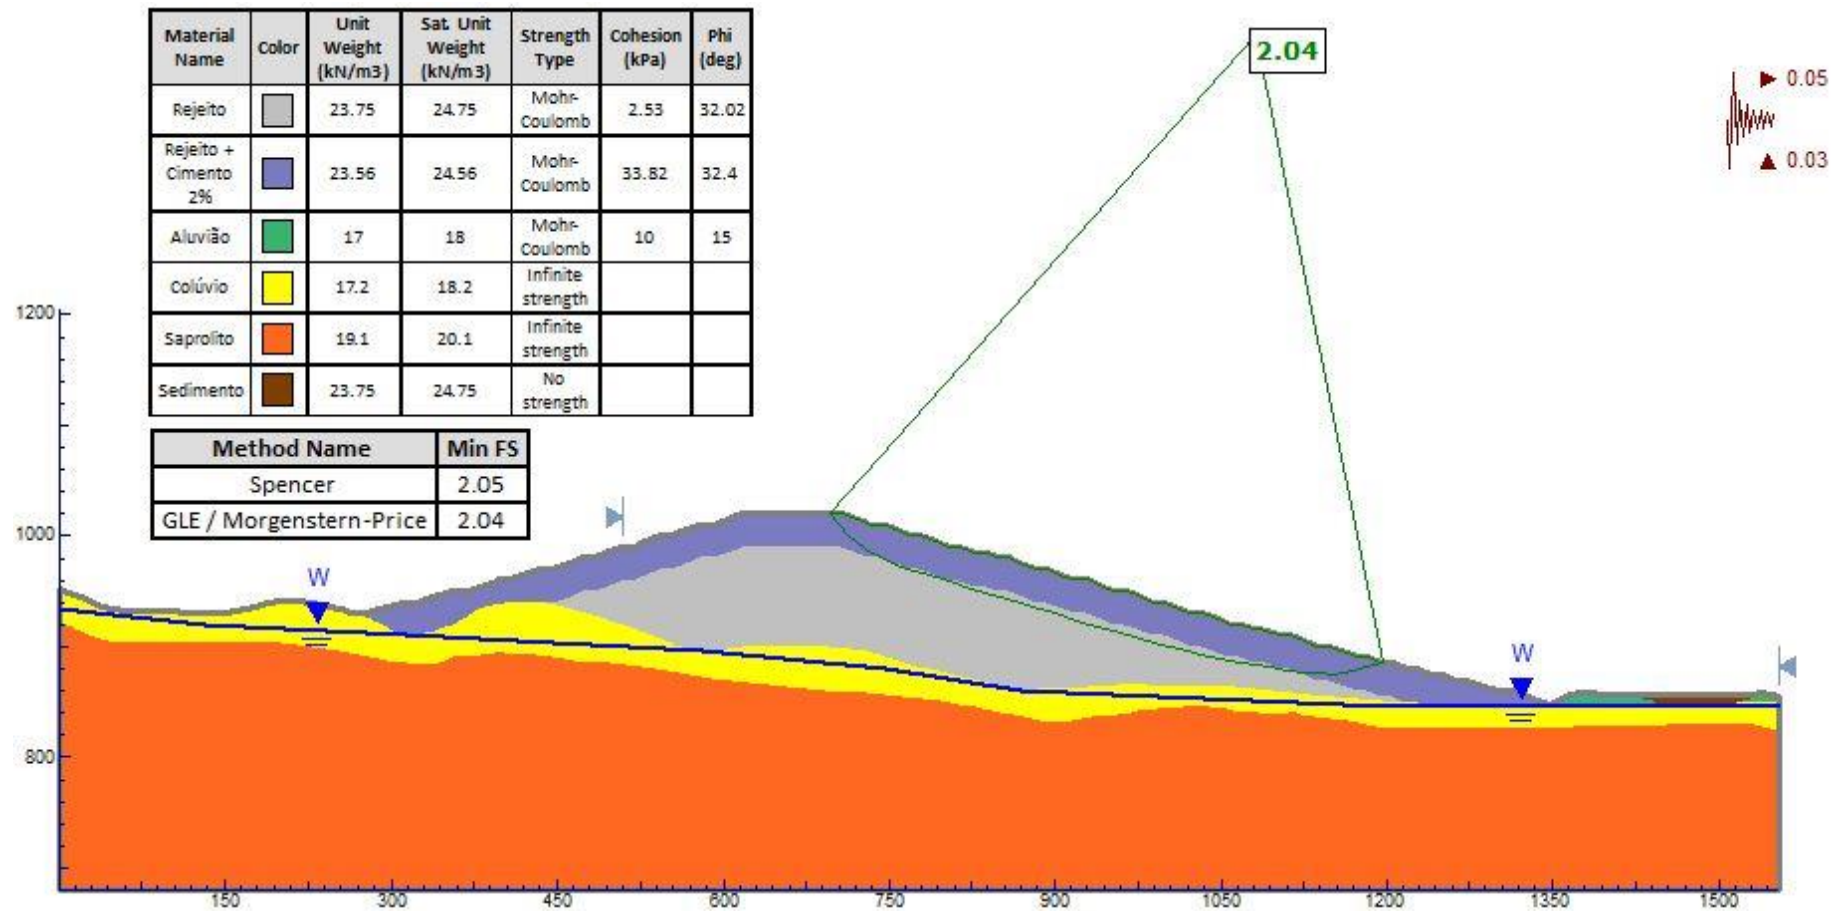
Análise de estabilidade – Rejeito + 2% de cimento – Pilha de 172 m – Face da pilha com utilização de aditivo – Superfície freática crítica – Talude esquerdo
